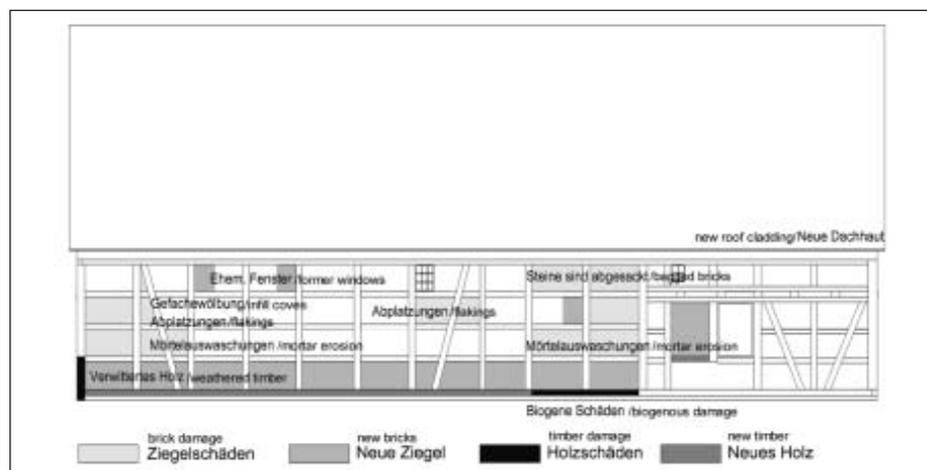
Schadenskartierung einer Fassade eines Vier-Ständer-Fachwerkhhauses
